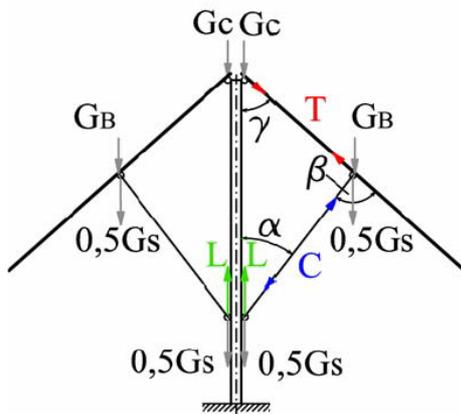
Gleichgewicht der Kräfte beim Hubvorgang - Druckstrebenvariante
